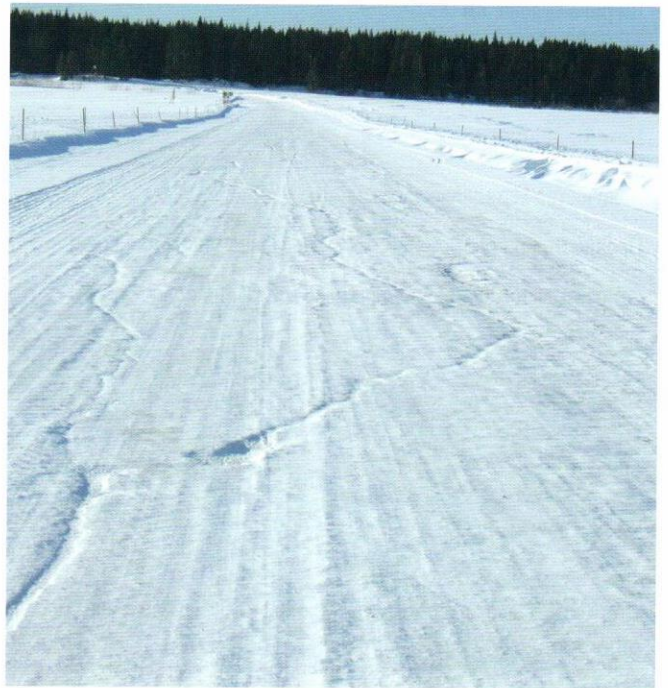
Сетка мелких нераскрывшихся трещин на армированном участке
